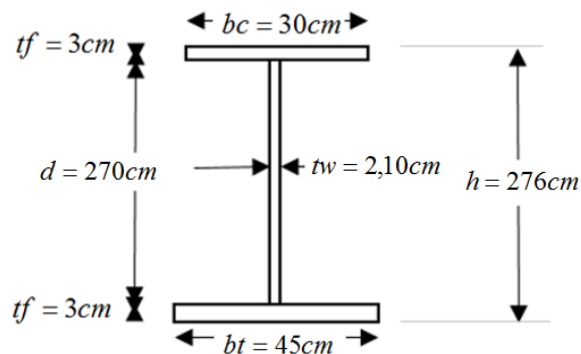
Dimensionamiento adoptado de la viga metálica en el centro de luz (abscisa 22500mm)
